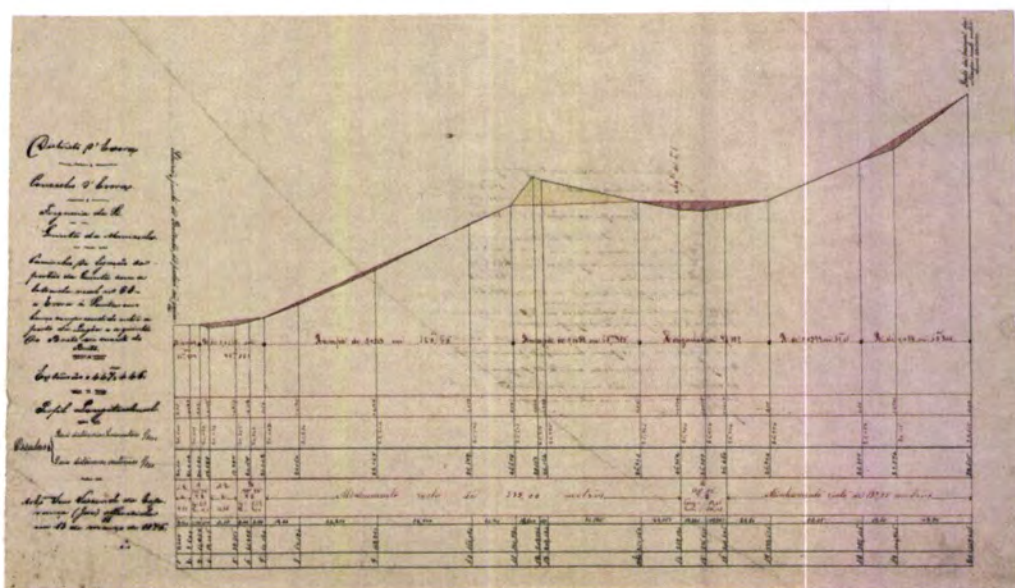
Planta do caminho de ligação do portão da quinta da Manizola, com a estrada real nº 68 – Évora a Santarém 1
